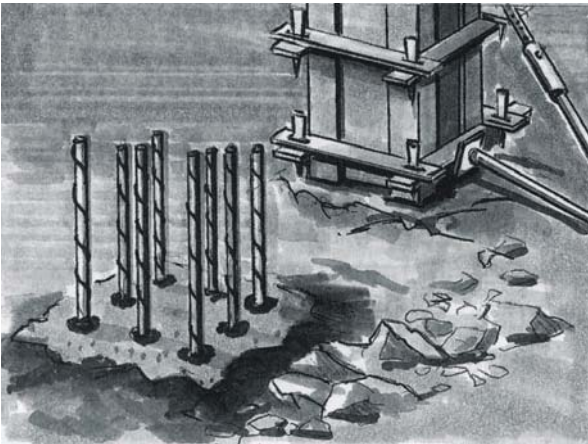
zeigt verschiedene Anwendungsbereiche von nachträglich eingemörtelten Bewehrungsstäben in Altbauten bzw. an bestehenden Bauteilen. Diese Art von Anschlüssen kann beispielsweise eingesetzt werden, um Öffnungen in Decken oder Wänden zu verschließen, Wände und Stützen an bestehende Bauteile oder auch auskragende Bauteile an die bestehende Struktur anzuschließen.
